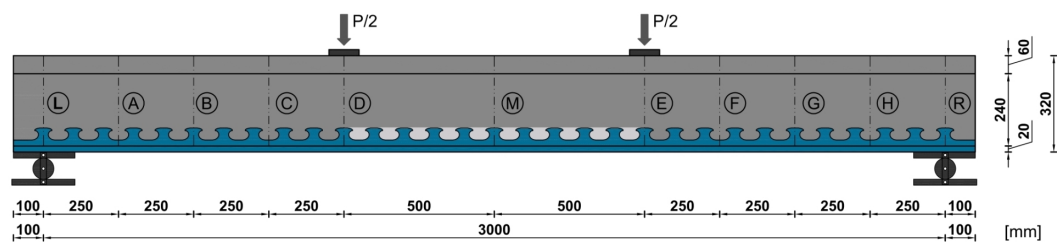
Prüfaufbau und Abmessungen für Verbundträger mit 30 cm Betonhöhe
